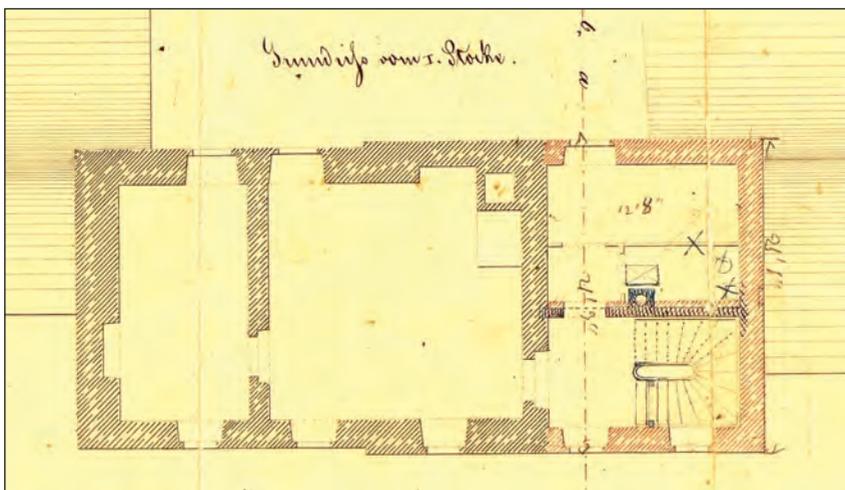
Umbauplanung altes Lehrerwohnhaus, 1. Obergeschoss (Planentwurf 1859)
